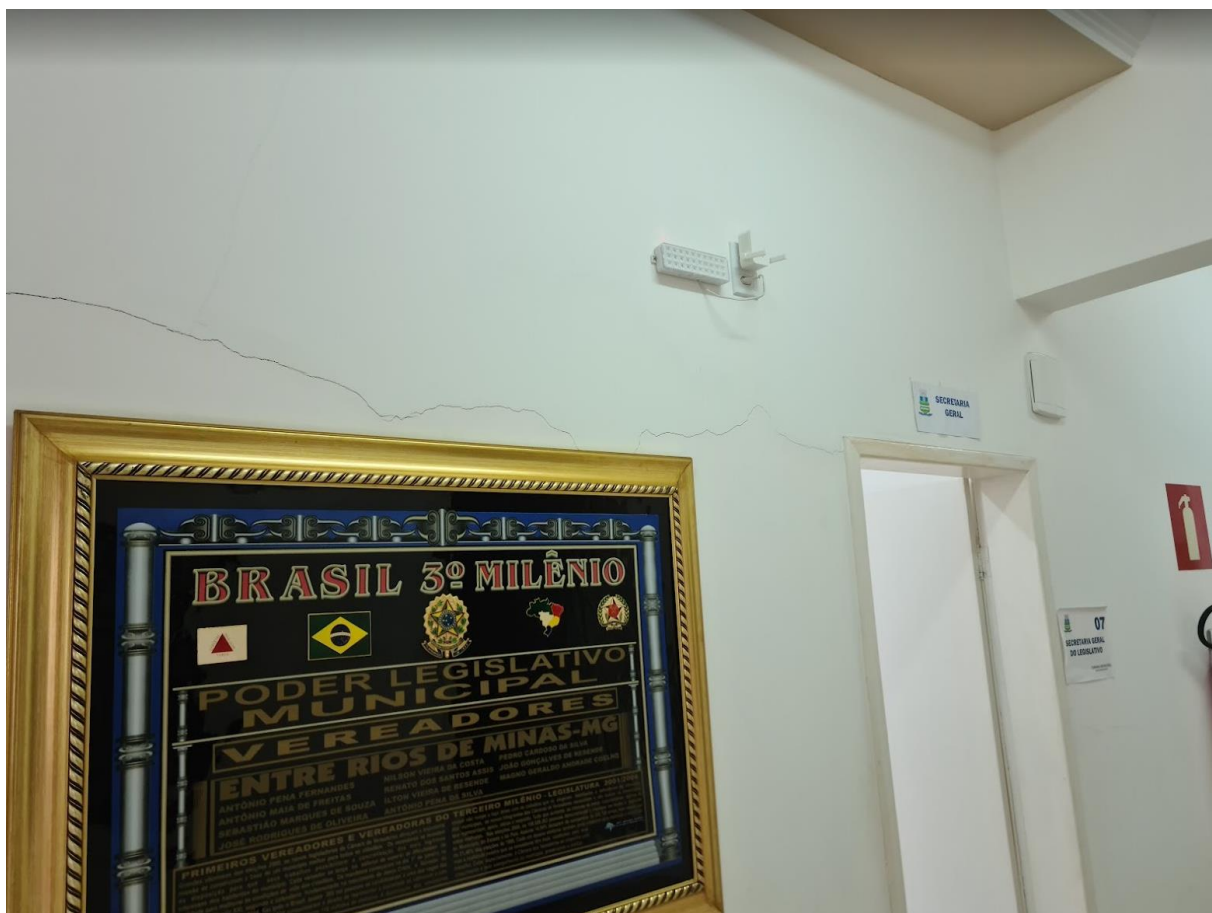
Trincas no corredor do terceiro pavimento.
